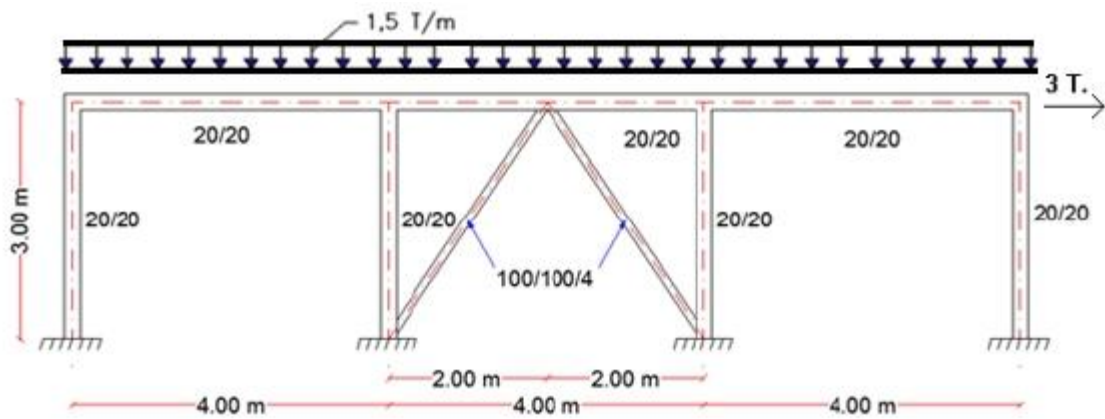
Estructura mixta de hormigón armado y diagonales de acero
